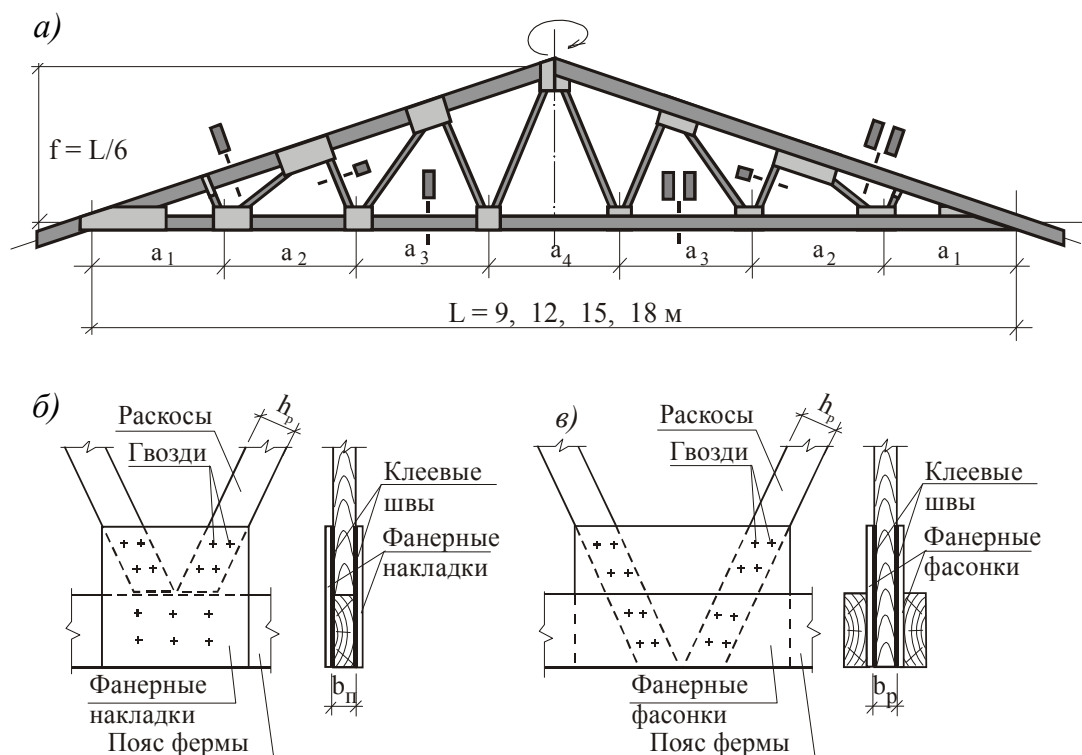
Ферма с узлами на фанерных фасонках и накладках: а – конструкция ферм; б – узел фермы с фасонками; в – узел фермы с накладками
